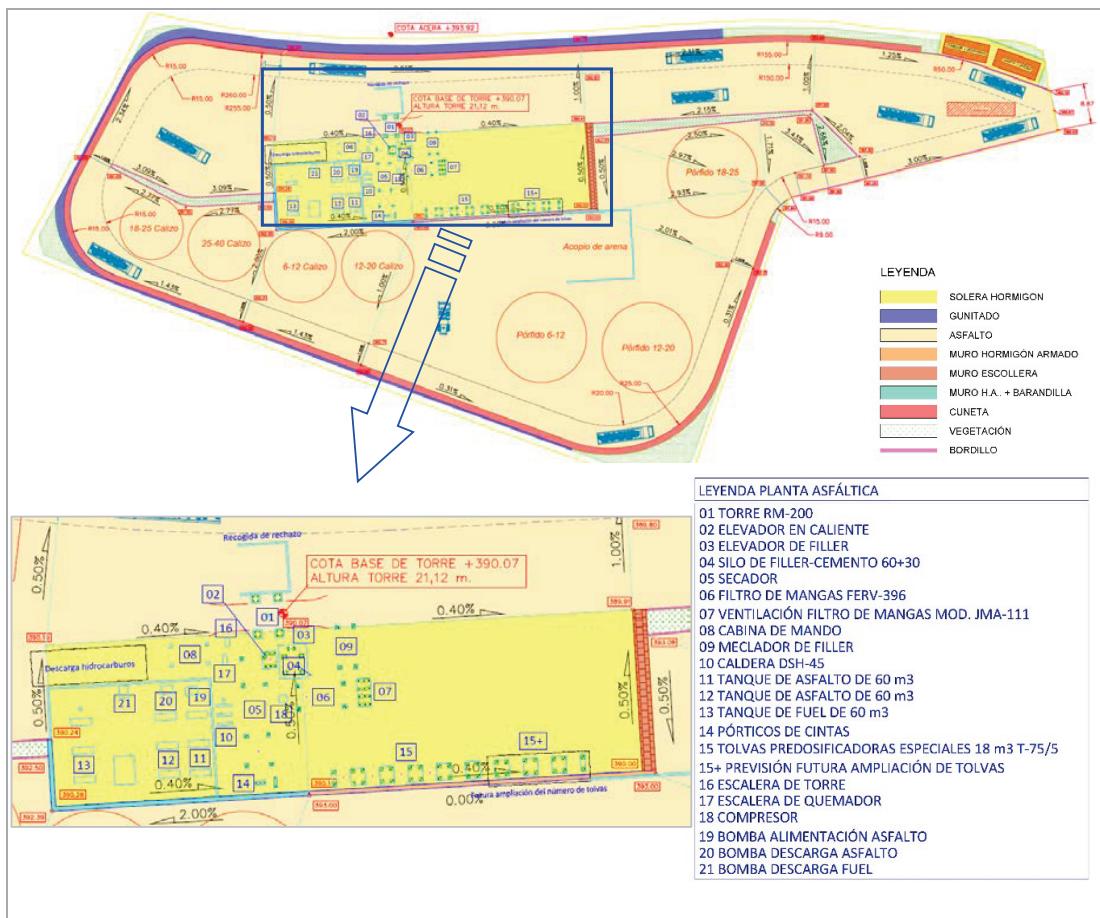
Planta general de las instalaciones y obras proyectadas
